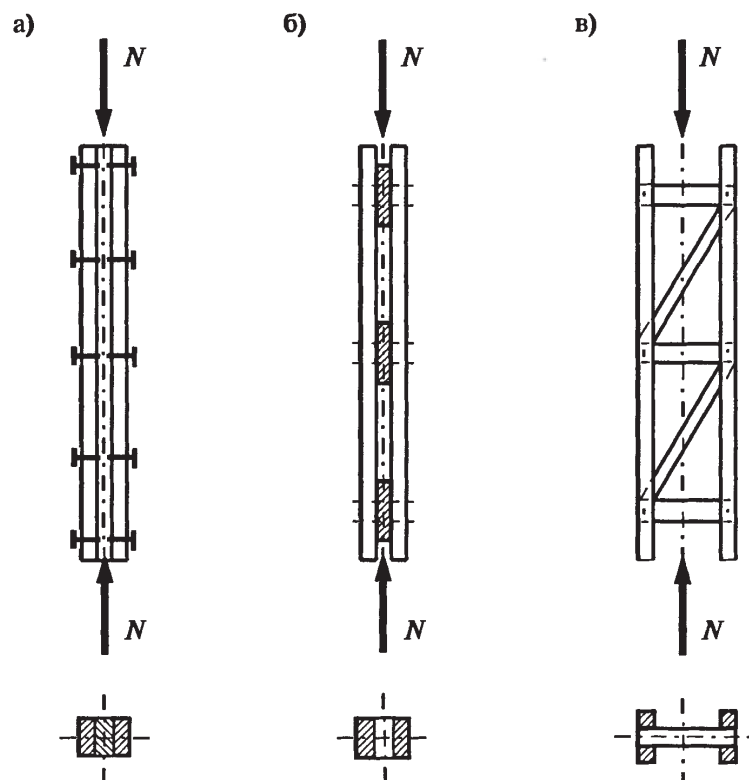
Стійки складового перетину, де: а – стійка з пакету дощок; б – стійка з короткими перекладками; в – стійка з наскрізною решіткою [3]
